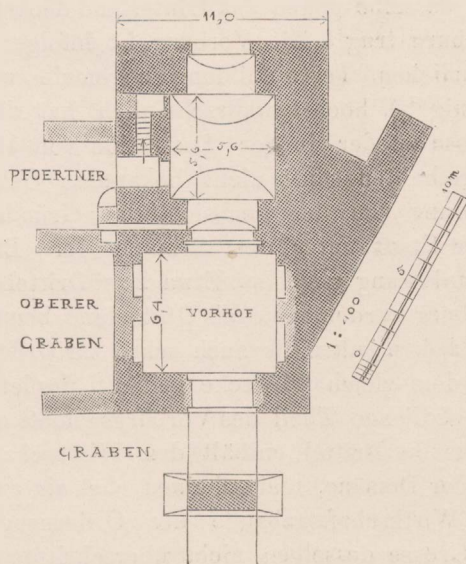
Schloss Roggenhausen. Grundriss des erhaltenen Thorturms.
